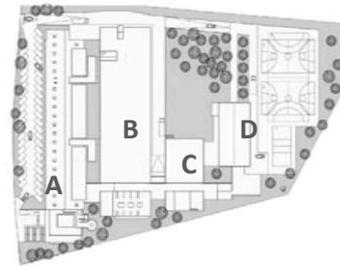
| Planta de Implantação, Escola Secundária Soares dos Reis
